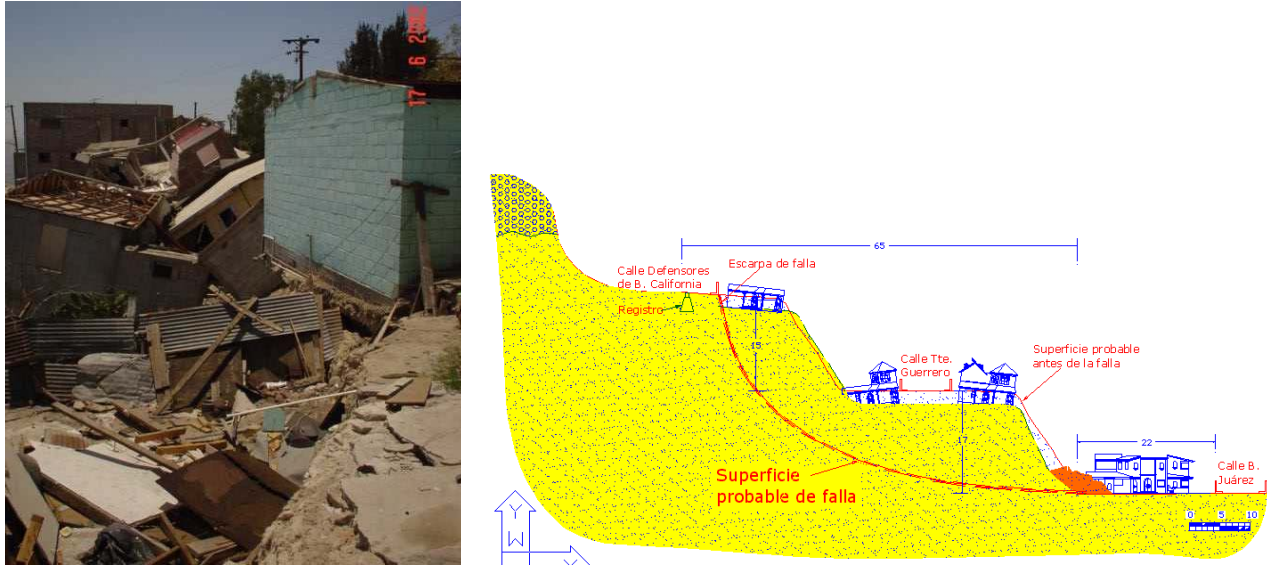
Deslizamiento de ladera con daño a estructuras
